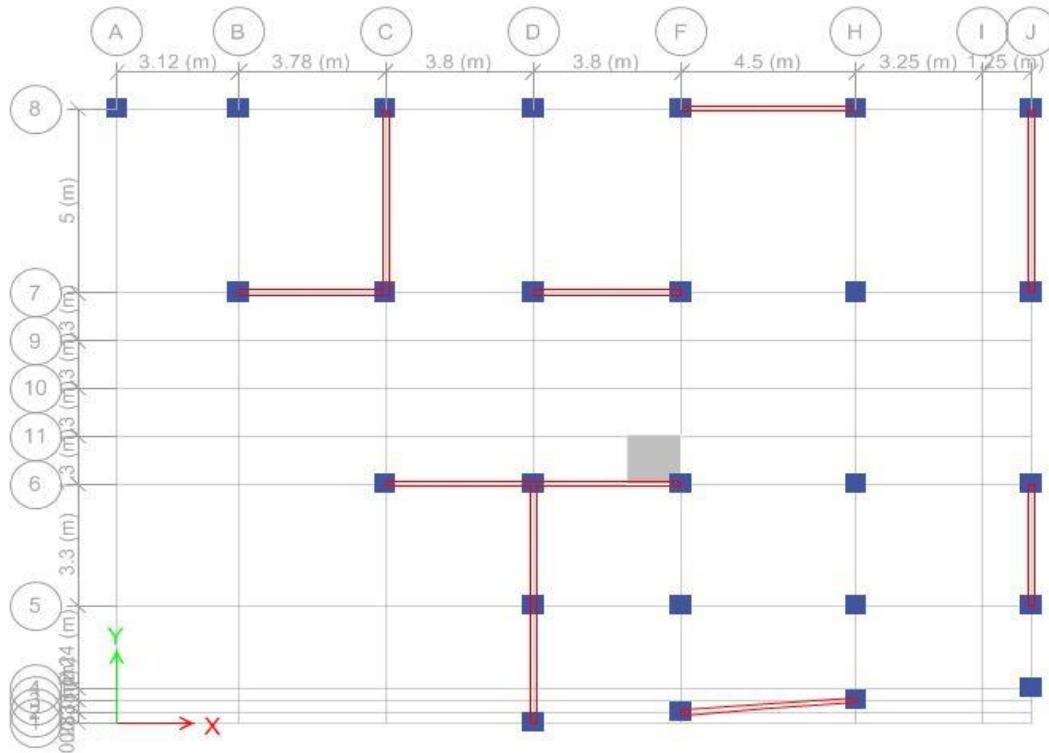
Disposition des murs-voiles dans la structure porteuse du bâtiment
